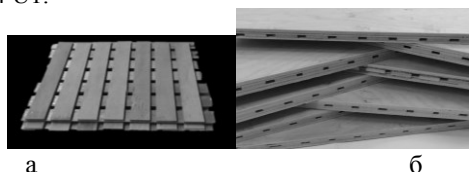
Фанерная панель: а – вид конструкции в процессе сборки, б – общий вид
